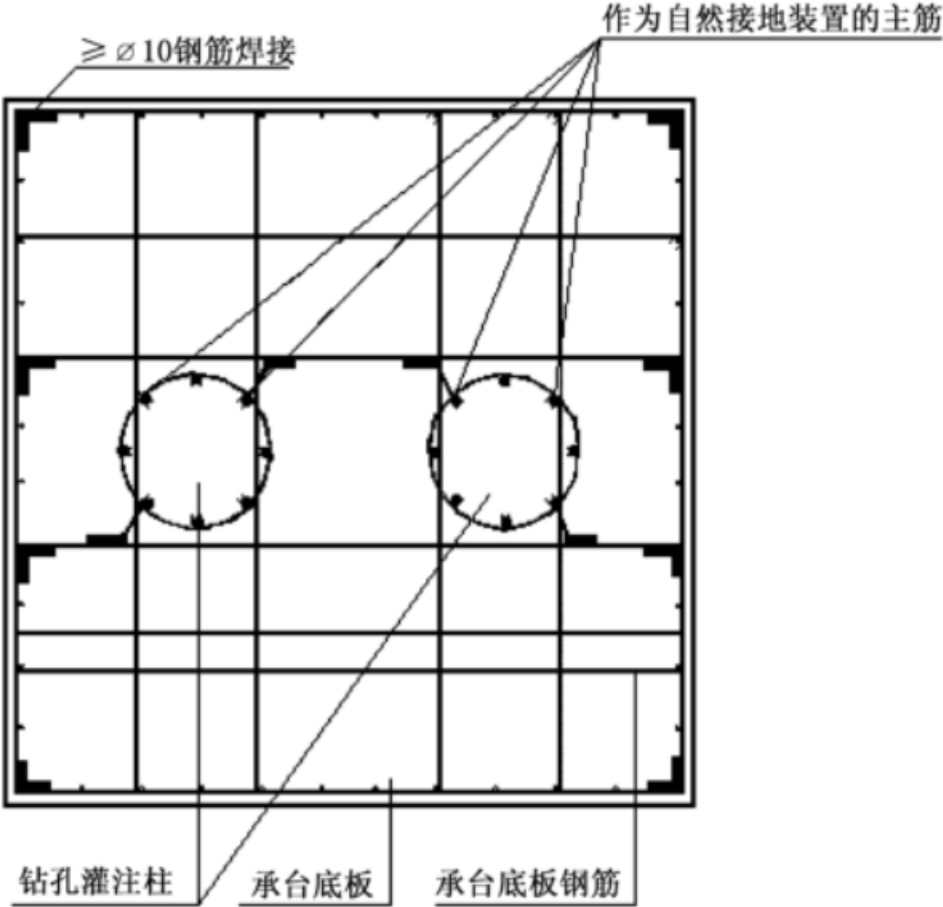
承台与桩基钢筋的焊接施工大样图
